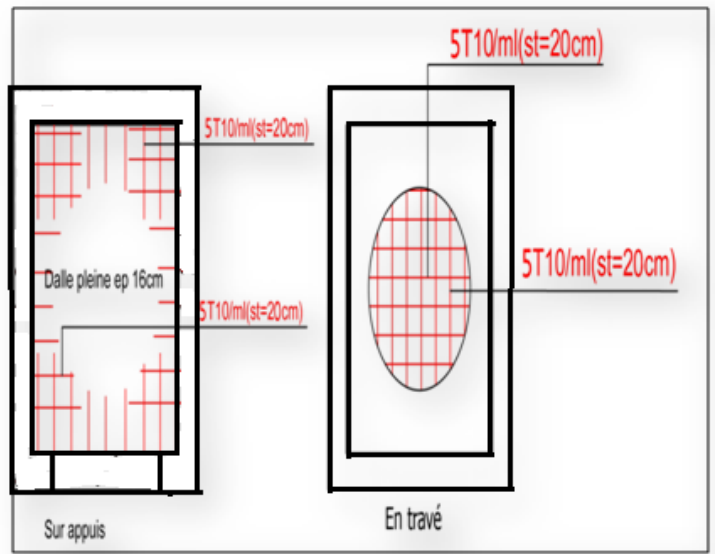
Ferrailage de la dalle d'ascenseur.
